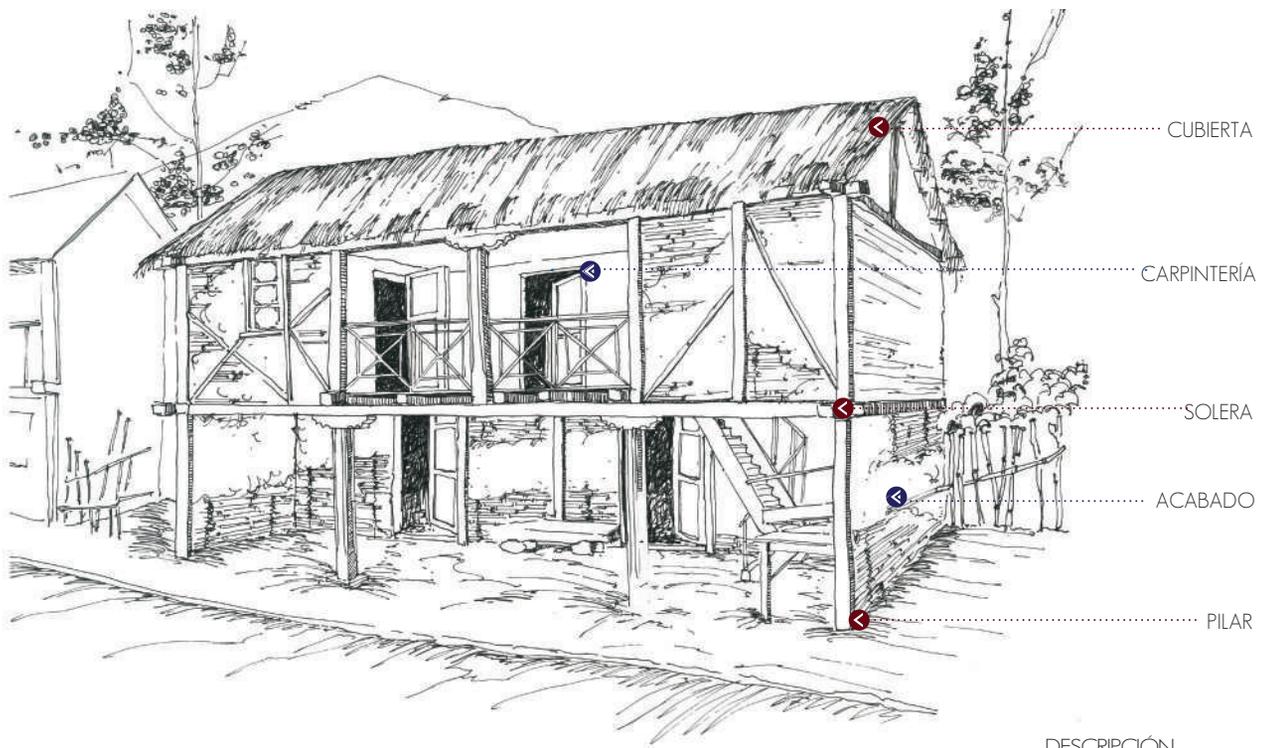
Elementos estructurales y no estructurales de la edificación.
